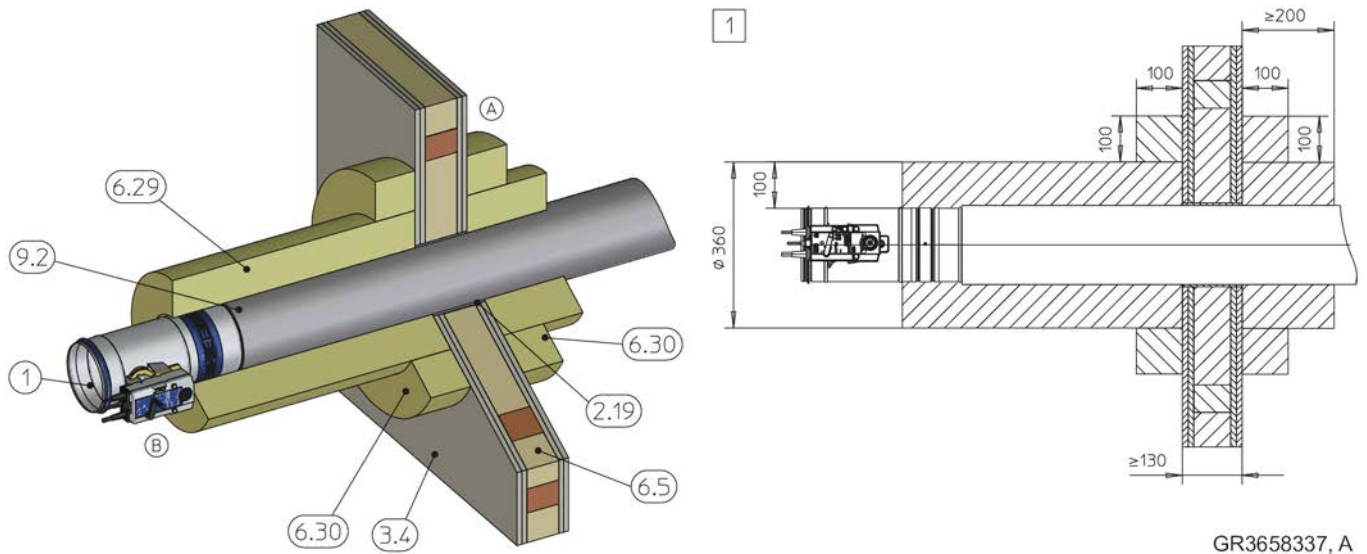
Tørr mørtelfri montasje i en lett skillevegg med bindingsverkskonstruksjon, med montasjesett TQ/TQ2
